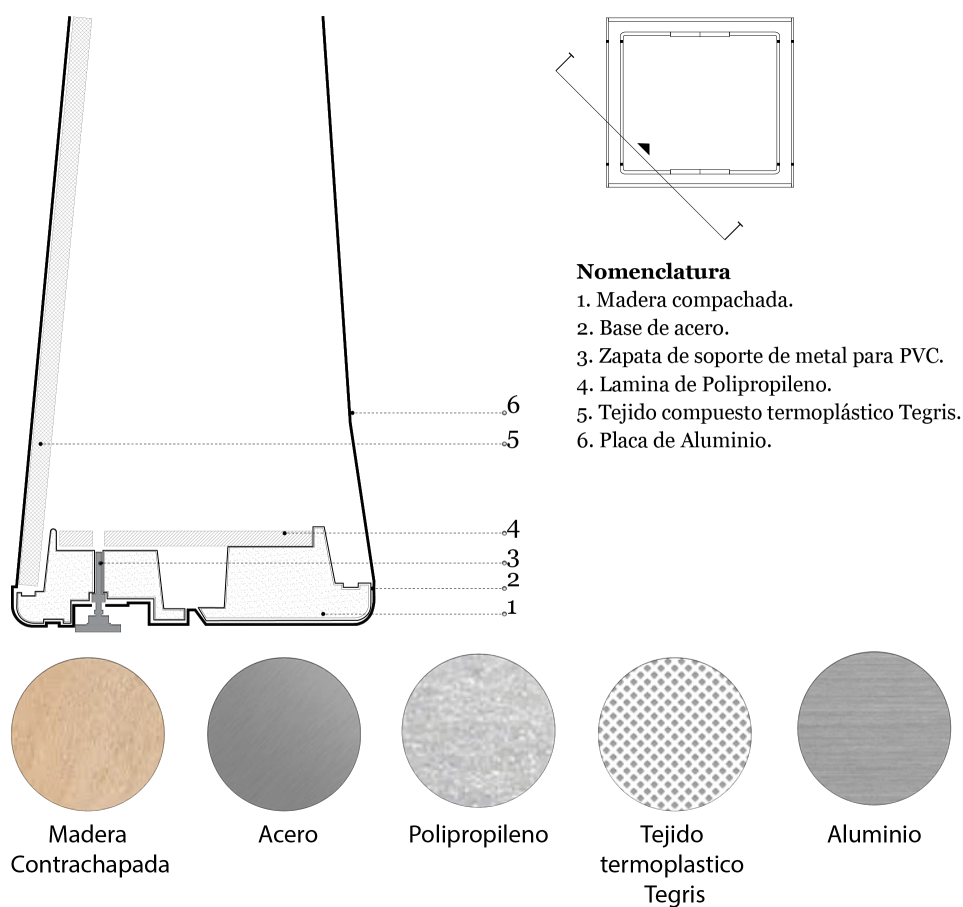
Detalle arquitectónico Exo Reaction. Fuente: (Rautiainen, 2016). Elaboración: Autores.
